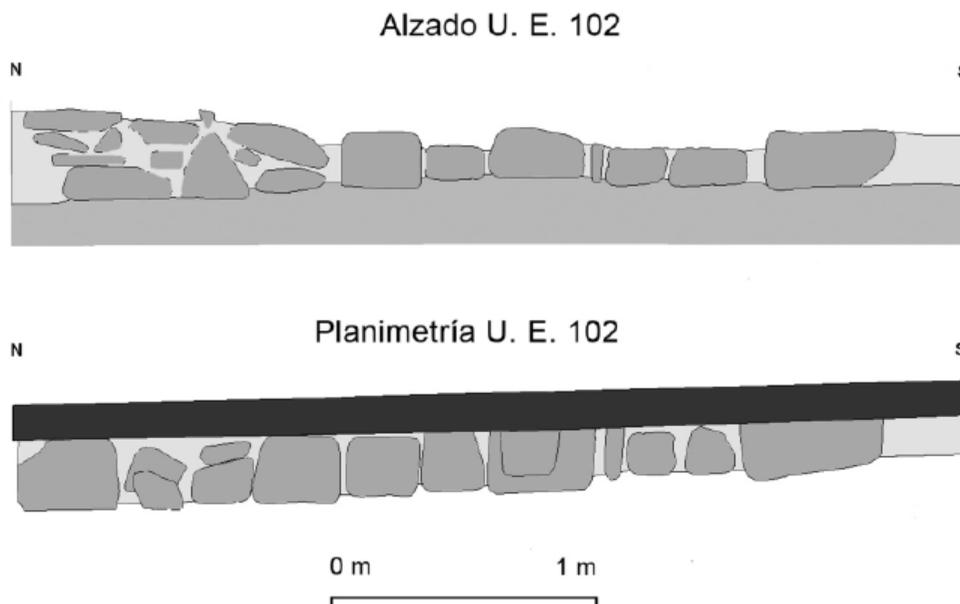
Alzado y planimetría de la unidad estratigráfica 102 (calle 7 de febrero de 1883).
